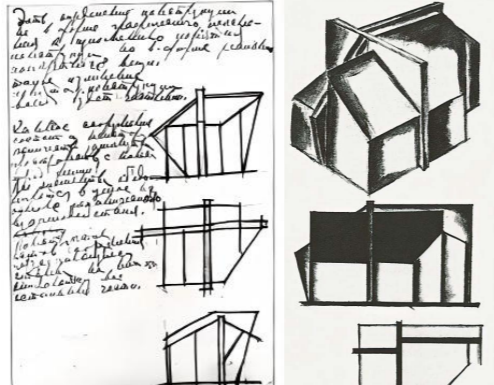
某实验性建筑项目, 图纸说明、轴测图、立面图和平面图, 1921年
